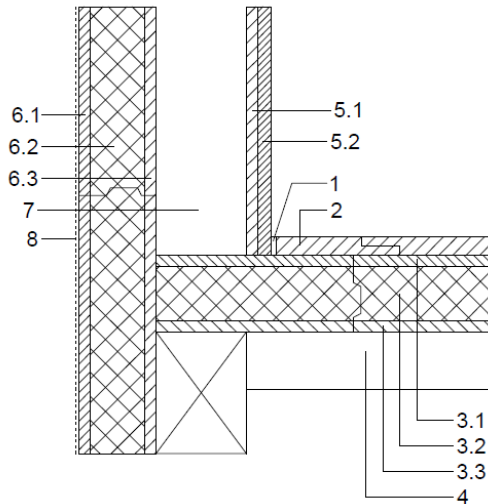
Encuentro tipo de fachada con paneles SATE y revestimiento interior COAT con forjado de entreplanta. Sección transversal vertical.
